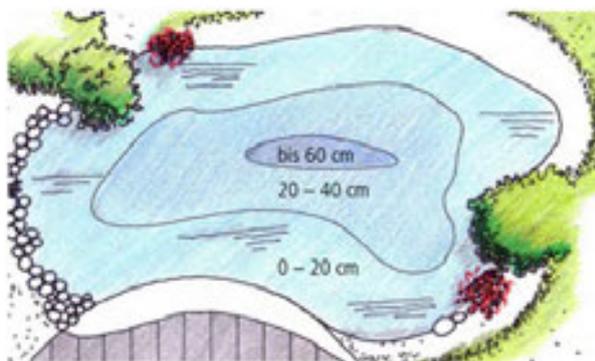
Grundriss Stufenbau (Quelle: BFU)
